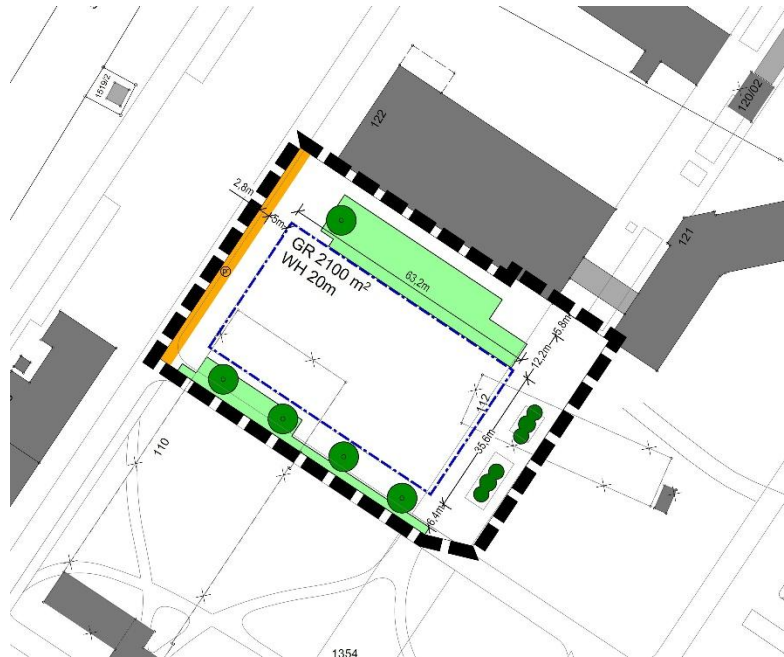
2. Änderung des ursprünglichen Bebauungsplans aus dem Jahr 2023
